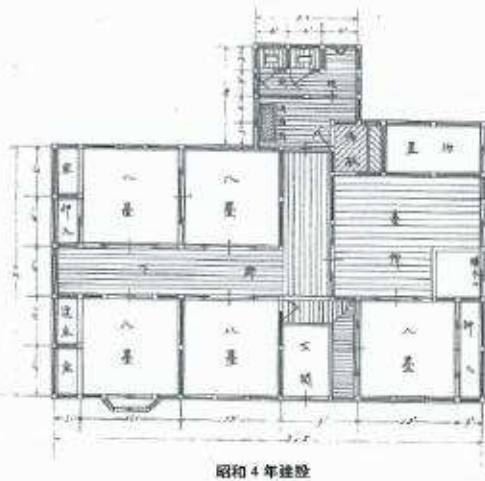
上風連駅通所平面図（札幌資料調査会作成）
